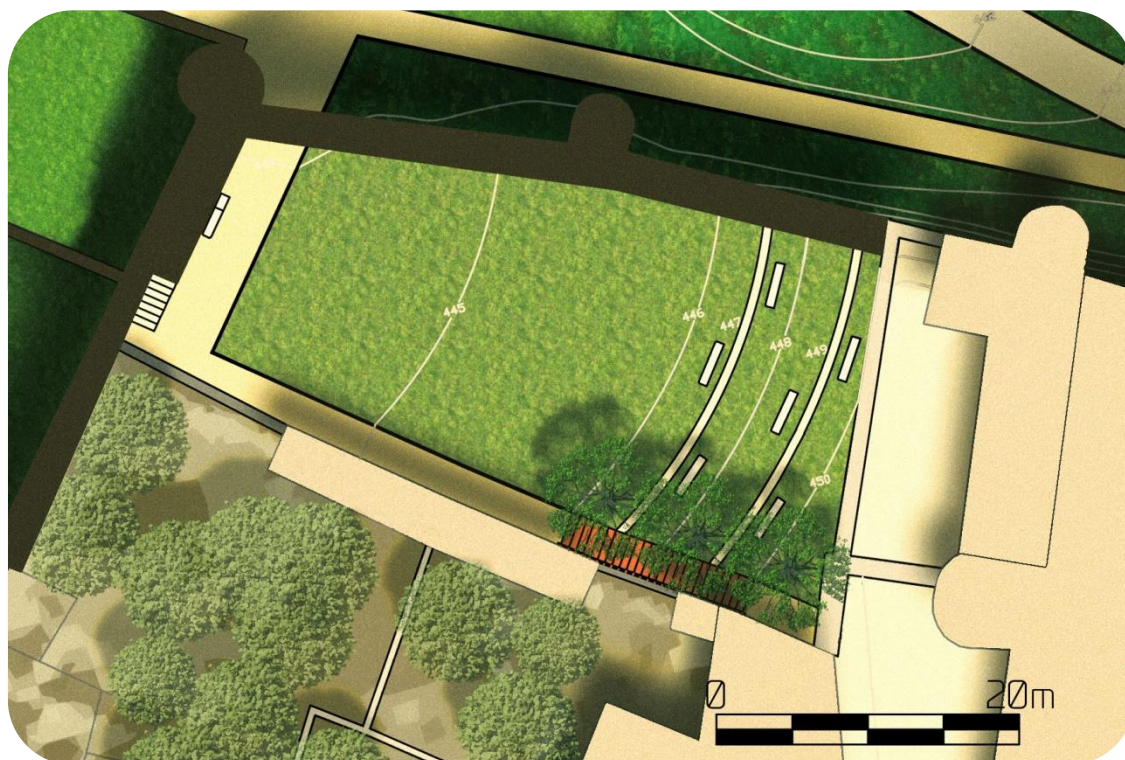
Planta do Jardim da Capela da Rainha Santa
